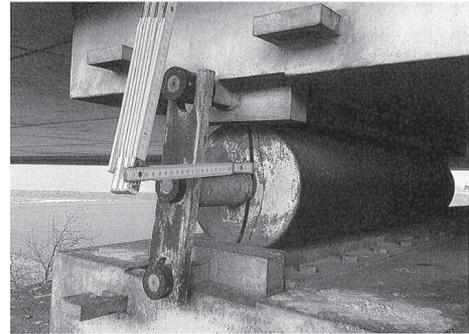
Teilweise aufgesplattetes Edelstahlrollenlager (oben) mit temporärer seitlicher Hilfsabfangung (unten) einer Brücke mit Baujahr 1975
